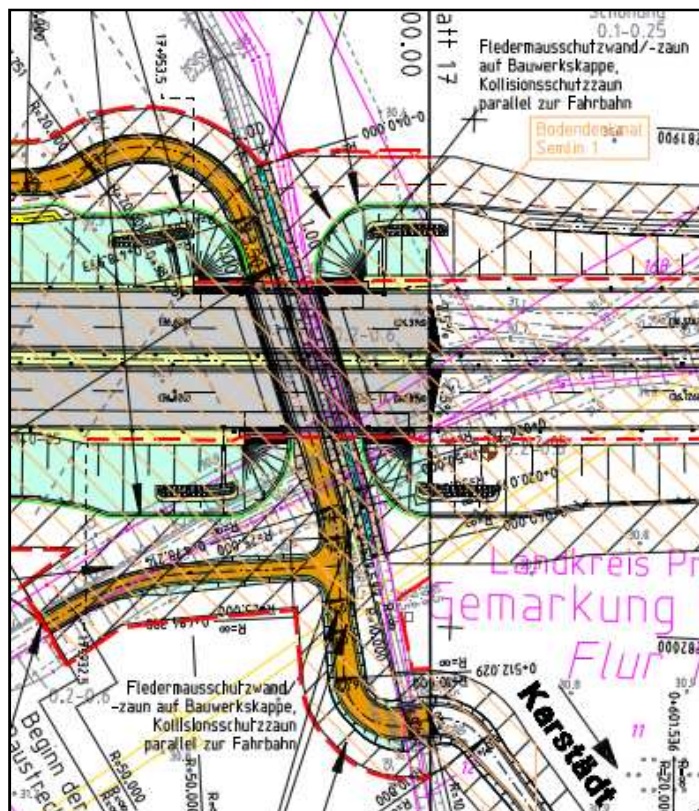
Lageplan Bau-km 17+000.000 bis 18+000.000 Querung Wassergrundgraben
